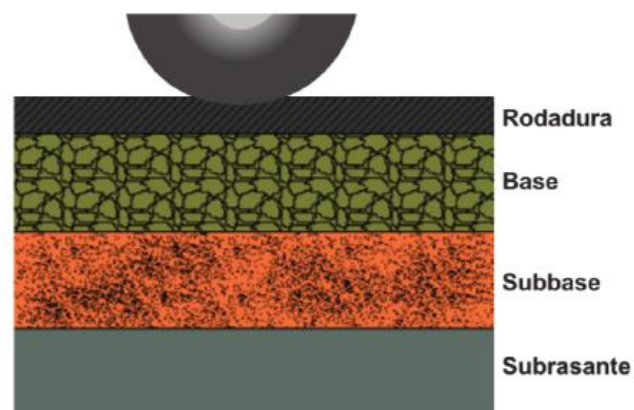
Estructura de pavimento flexible (Recuperado de [13]).
